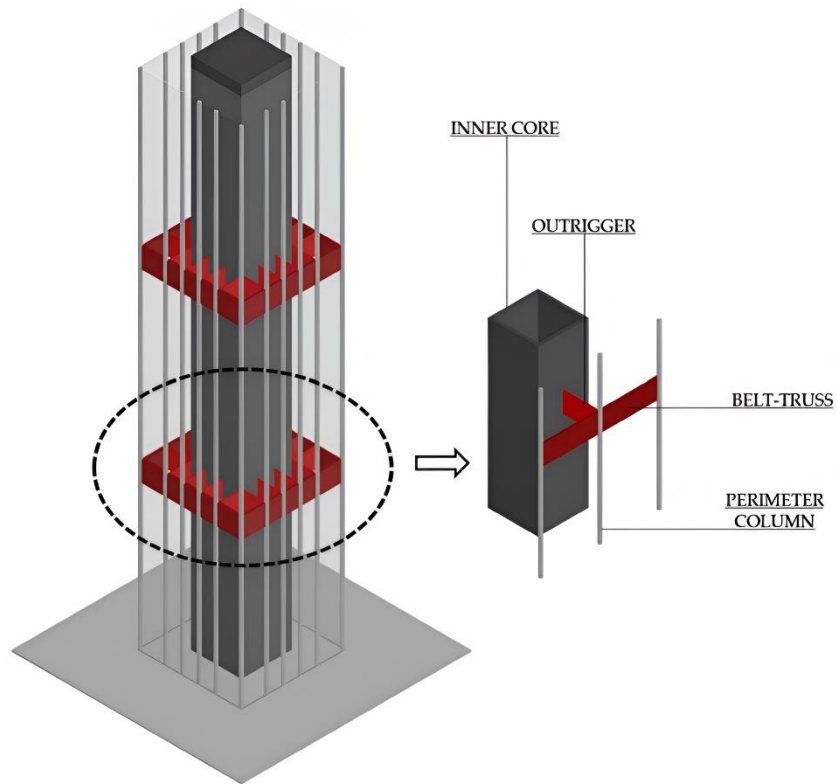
schematizzazione delle principali componenti del sistema strutturale di tipo telaio con outrigger e belt truss [7].
